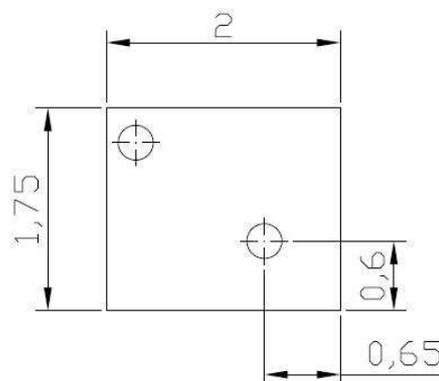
Distribución en planta de las luminarias de los baños 3 y 4.
